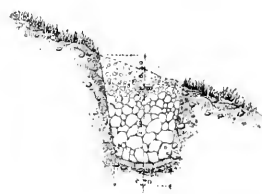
Coupe d'un Drain de 2^e ordre.
